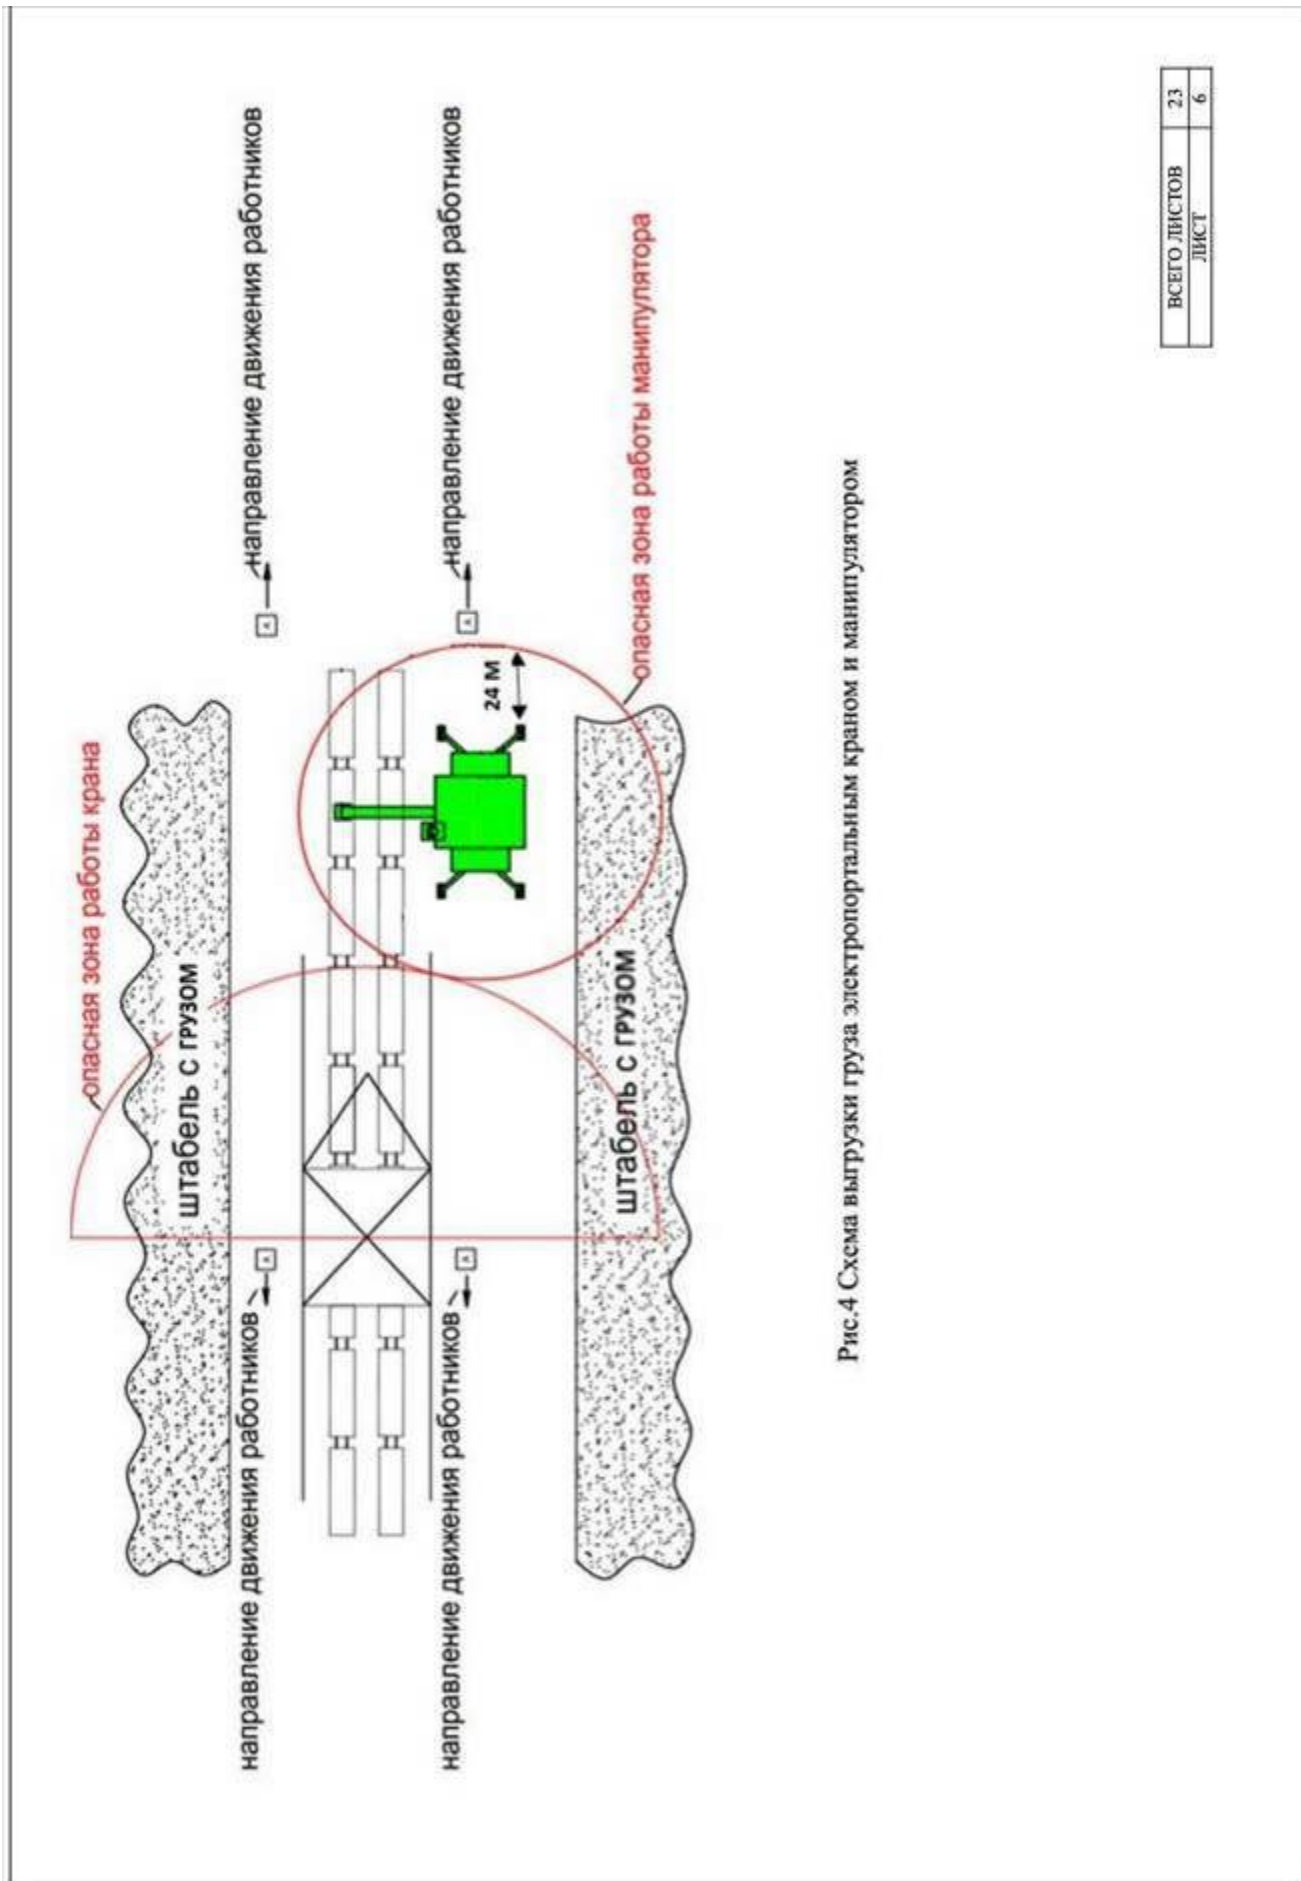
Схема выгрузки груза электропортальным краном и манипулятором
